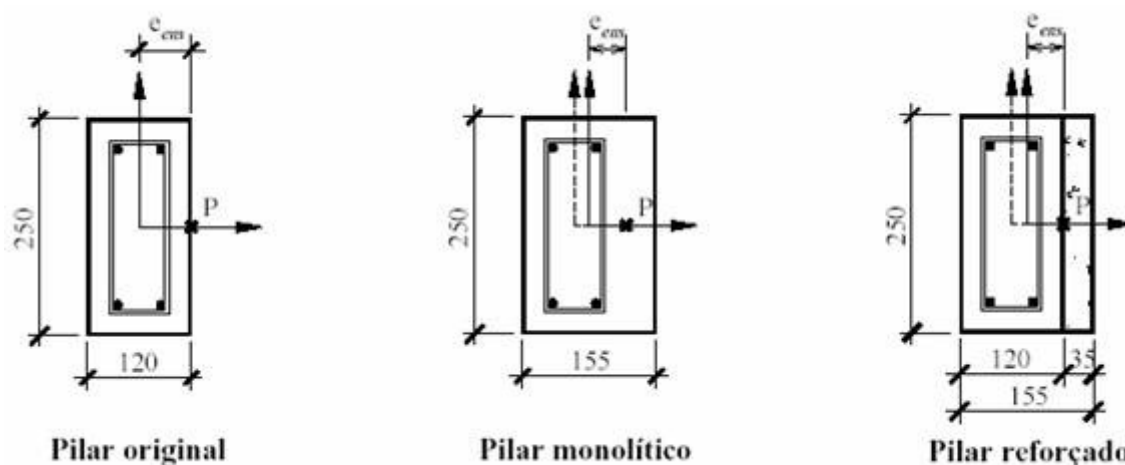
Características das seções transversais de todos os pilares (e_{ens} : excentricidade de ensaio; P: carga aplicada; Dimensões em milímetros)
